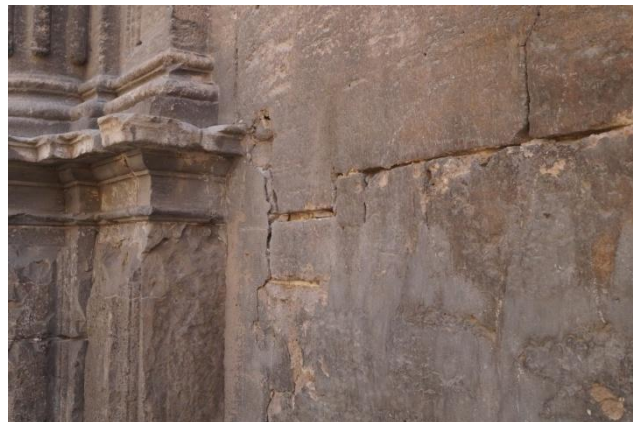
Fotografía fisura Fachada Calle Cementerio de San Juan. Fuente: (propia)
